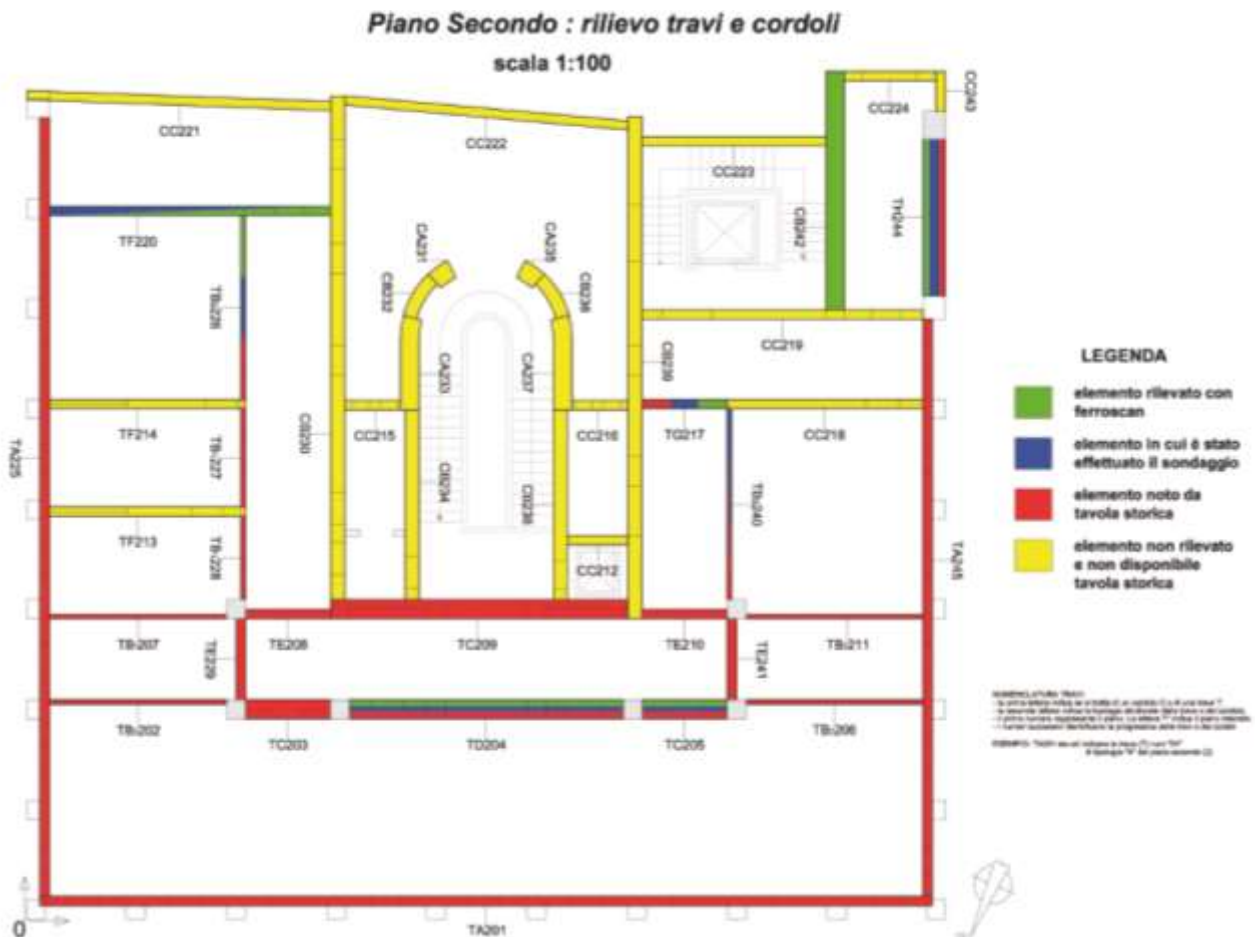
Pianta con indicazione della nomenclatura adottata per le travi del piano secondo.
